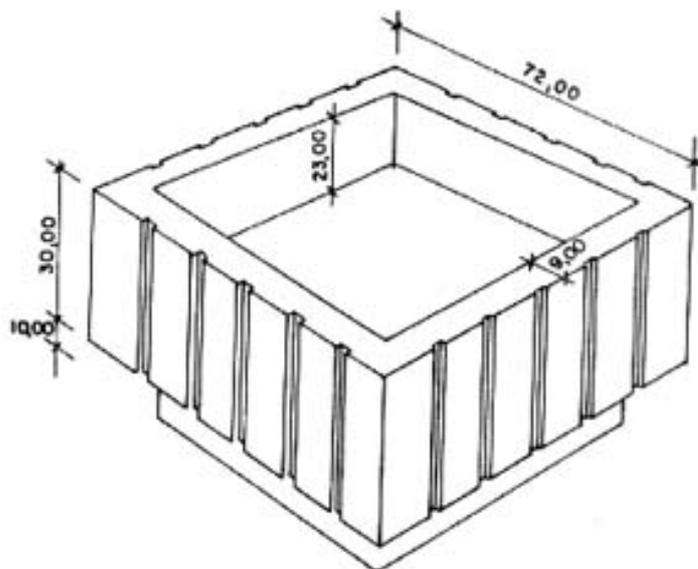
Tipo de floreira utilizada em concreto sem fundo.
